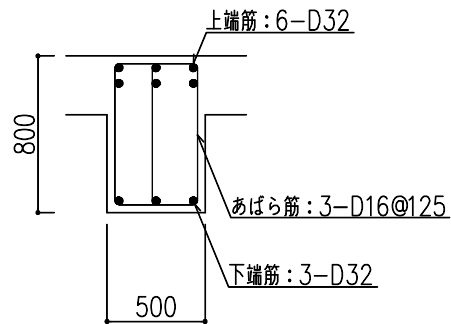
大ばりの配筋図（地下1階，YC通り X33～X34通り間，端部）（単位：mm）
